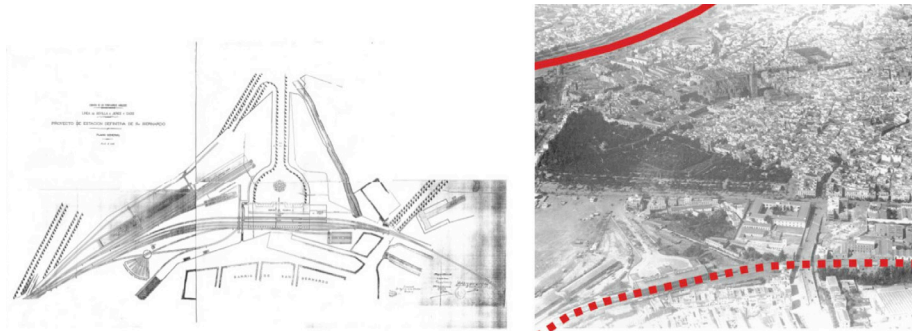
Planimetría original de la estación, archivo de RENFE y fotomontaje de la autora sobre foto aérea 1926
